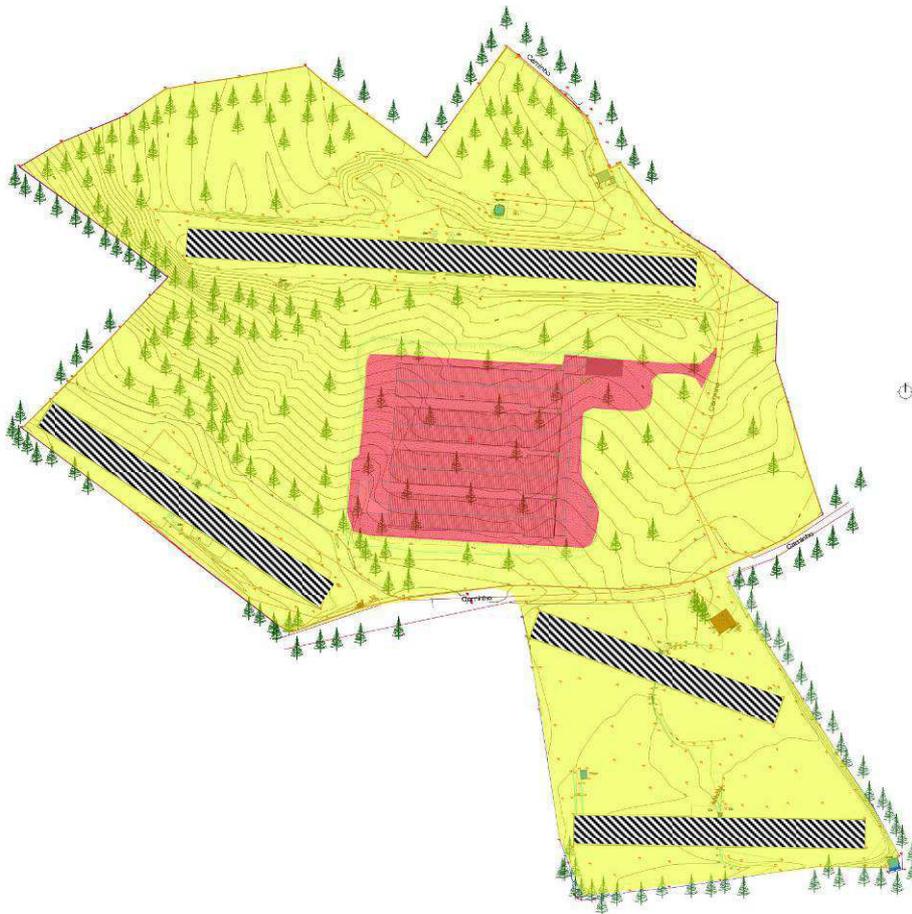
Planta da propriedade visada. Assinalados com padrão de linhas diagonais: as áreas actualmente edificadas, a rosa: áreas a construir.
